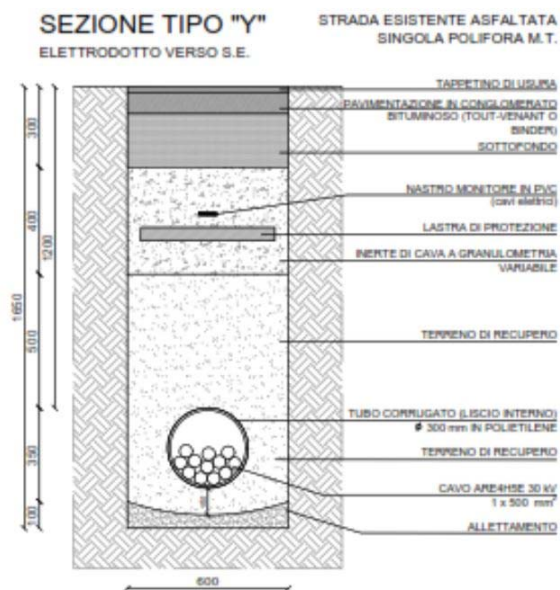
Sezione tipo Y cavidotto esterno MT verso SE
